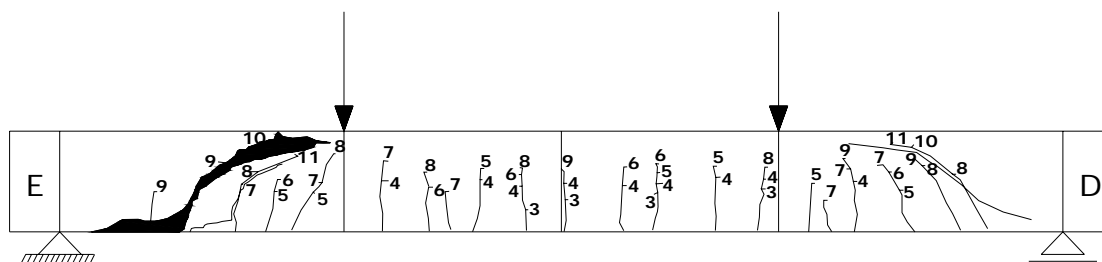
Padrão de fissuração para a viga V80-2 com armadura transversal
